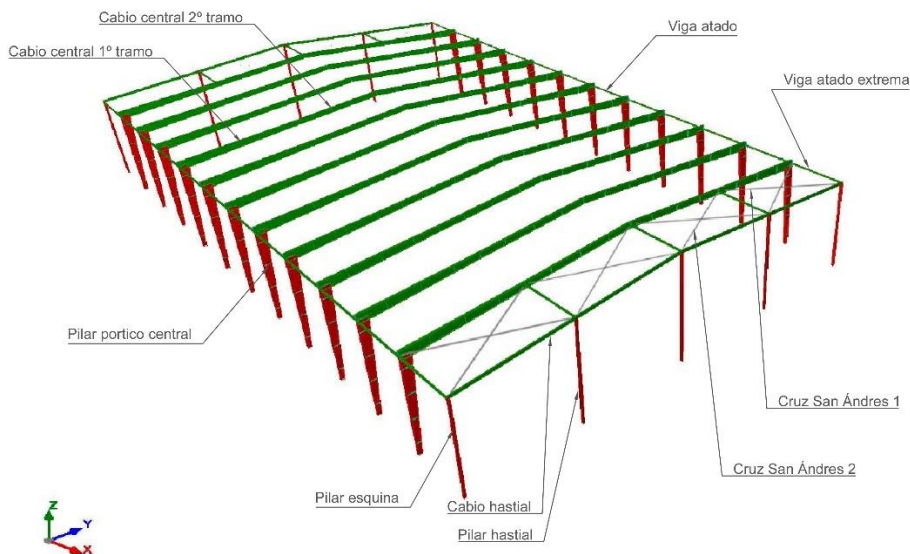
Vista 3D tipología Pórtico de Sección Variable
